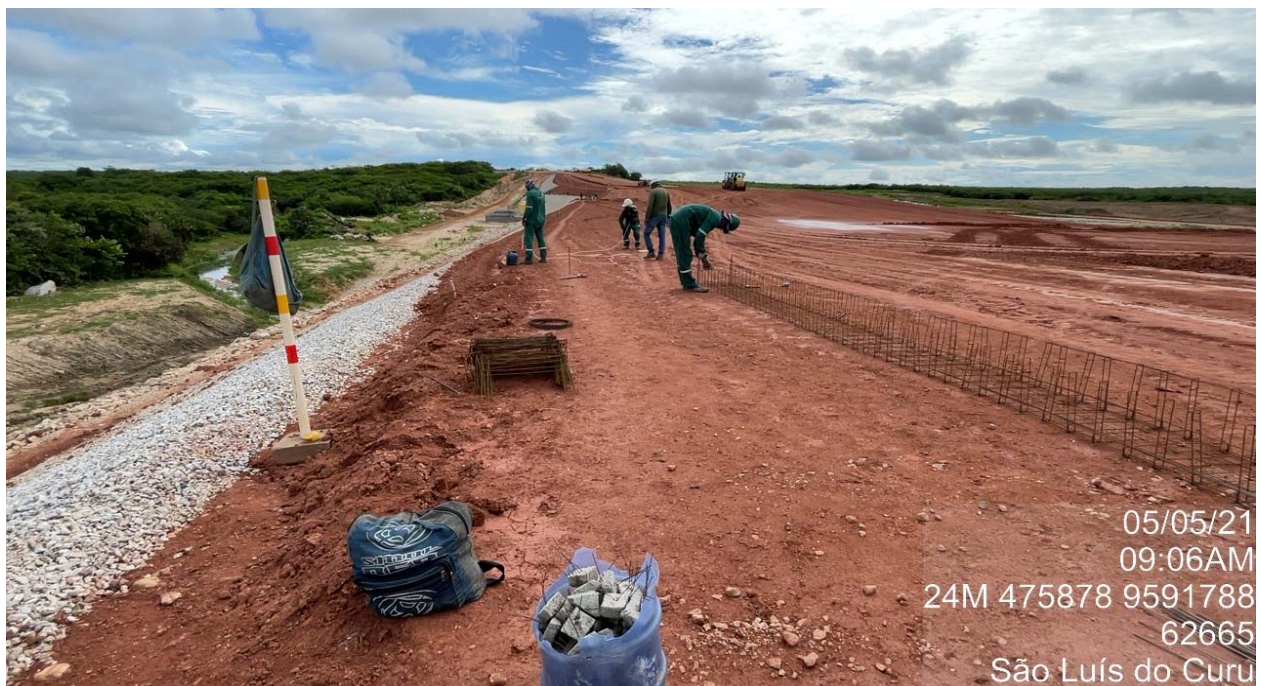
Execução de formas e ferragem para canaletas de jusante
